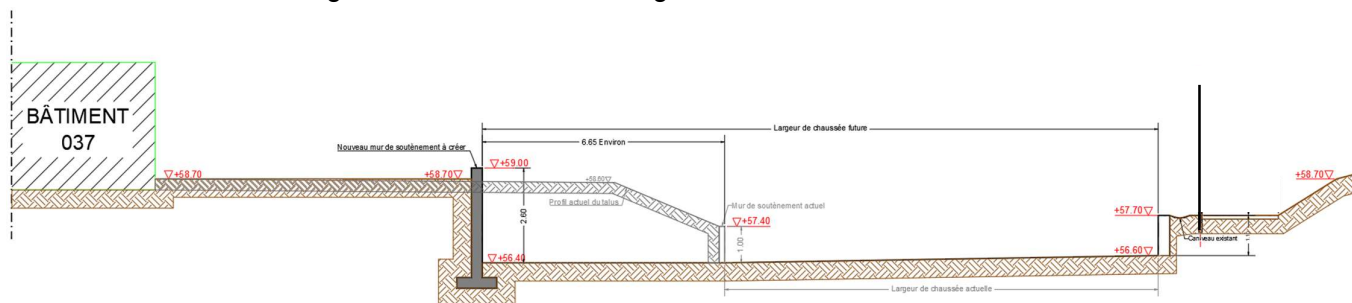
Coupe sur la zone 2 – existant et projet [R 3]
